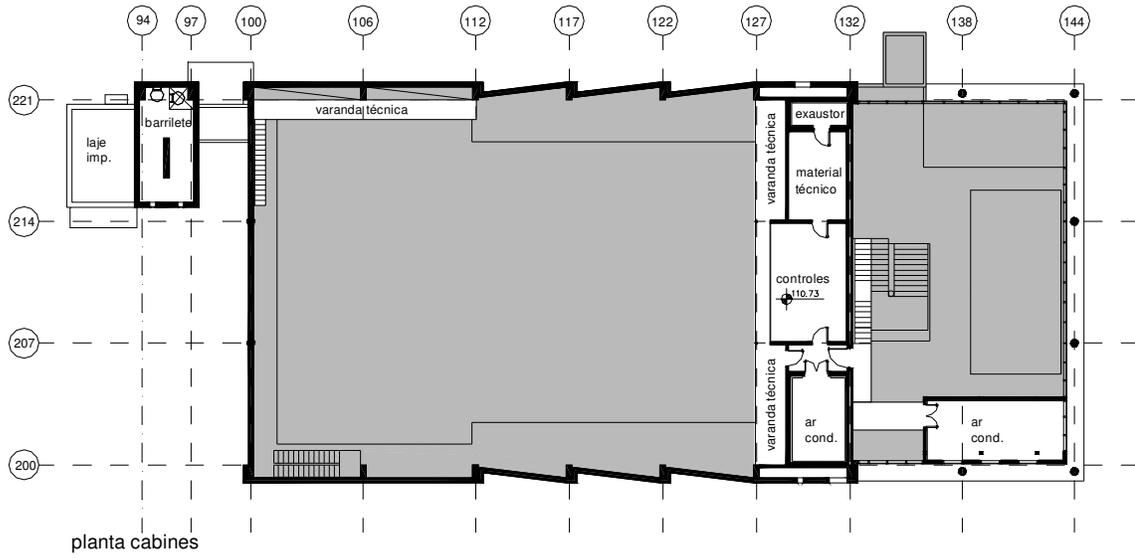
Planta das Cabines – Teatro Santa Cruz – Sem Escala
